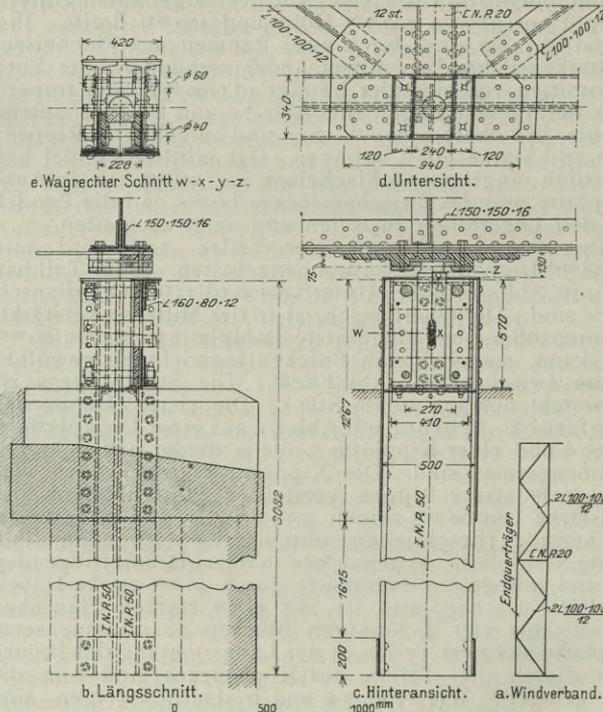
a—e. Lagerung und Verankerung des Windverbandes. Kaiserbrücke in Breslau.
